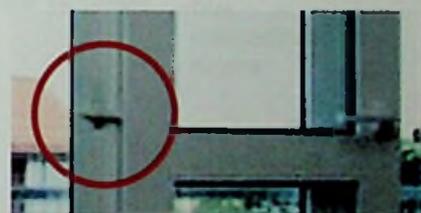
Detalhe da trava de segurança das folhas das janelas do pavimento superior
